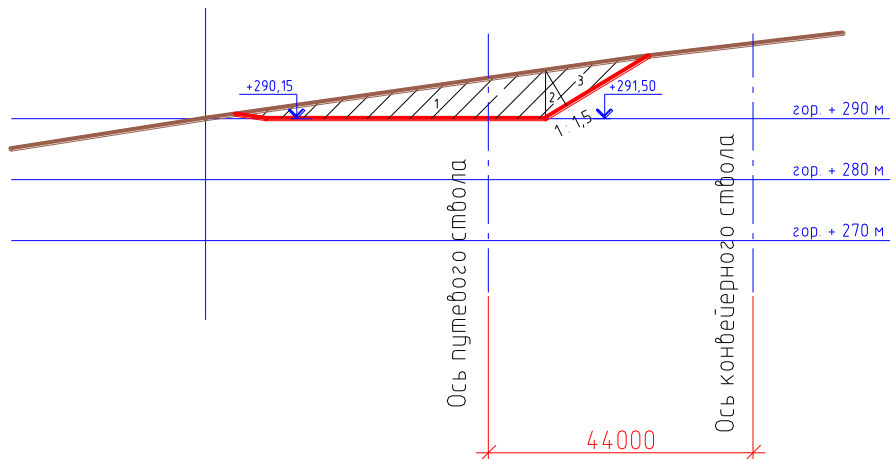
Поперечный разрез 2-2 площадки 1
